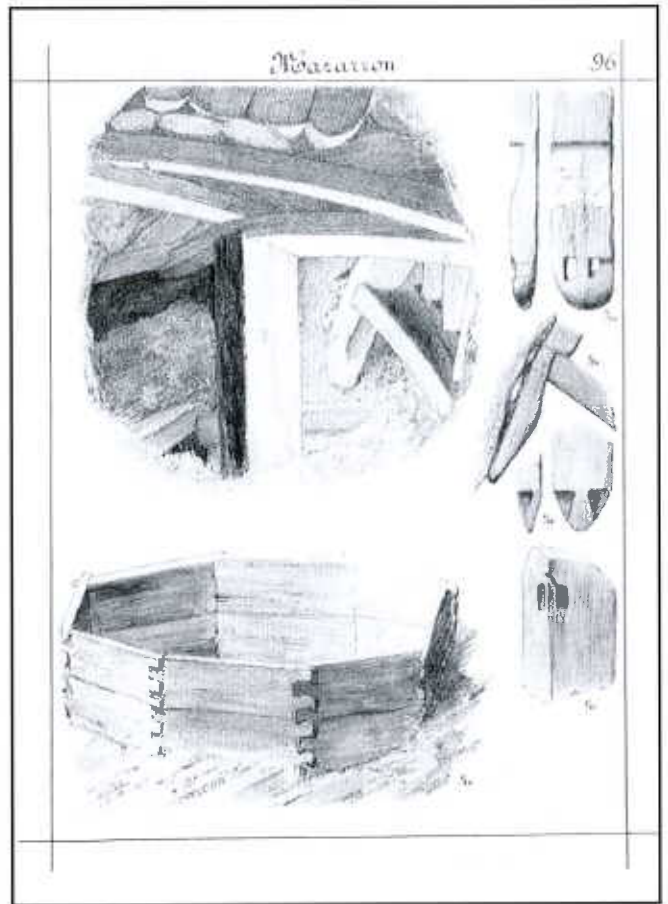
Coto Fortuna. Dibujo o lámina n.º 96 perteneciente a la obra *España prehistórica* de Luis Siret, 1891: 347: *Detalle de la entrada a la galería citada anteriormente. Detalle de los postes. Vista reconstruida de un pozo.
